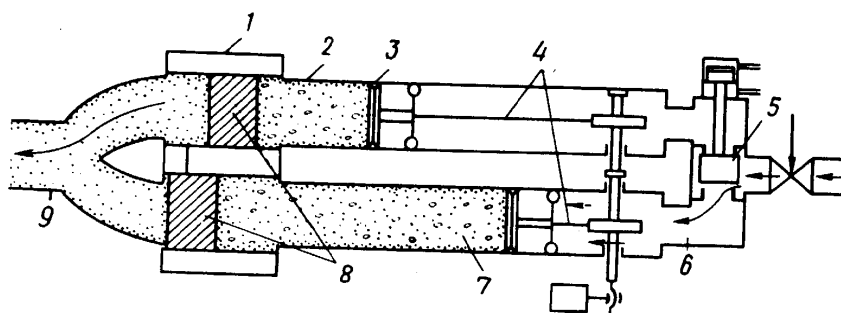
Схема бетононасоса со свободноплавающим поршнем: 1 – приемный бункер; 2 – рабочий цилиндр; 3 – поршень; 4 – гибкая связь поршней; 5 – гидрораспределитель; 6 – вода; 7 – бетонная смесь; 8 – шиберные заслонки; 9 – бетоновод
